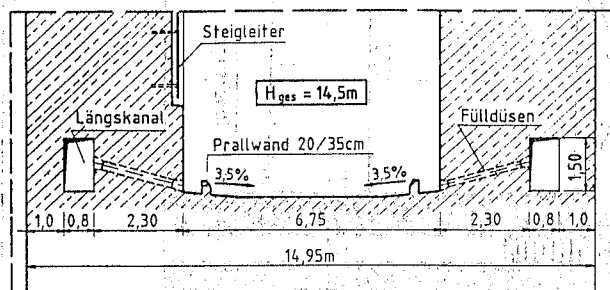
Längskanäle und Fülldüsen im Kammerquerschnitt (Bestandszeichnung der Saarschleuse Serrig)
